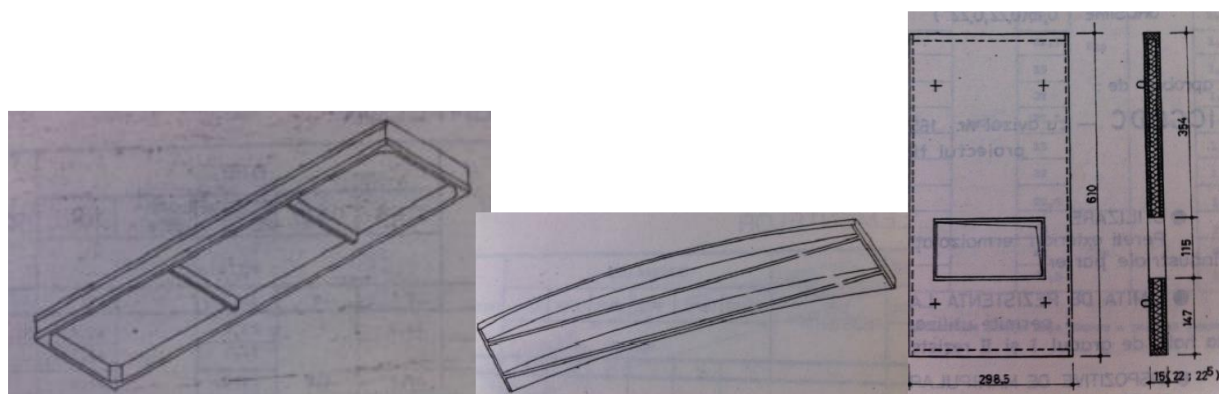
Soluții de închidere pentru halele pe structură din beton armat [68]
